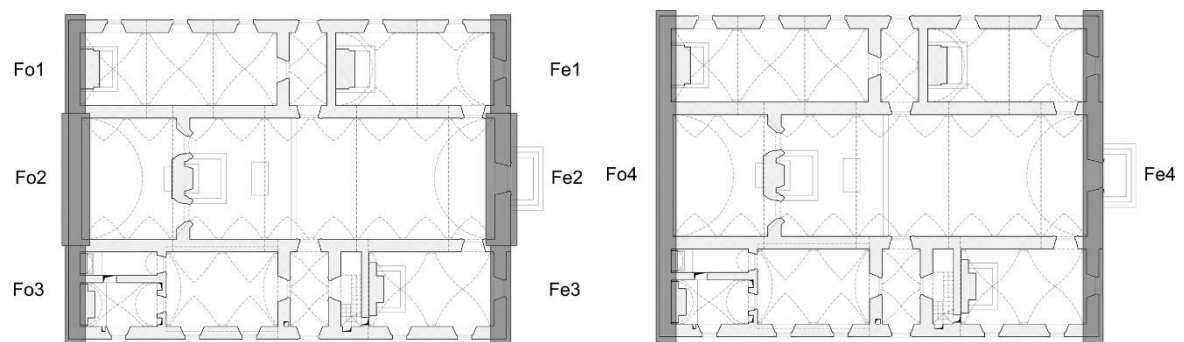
Pianta riportante la localizzazione degli elementi indagati.
